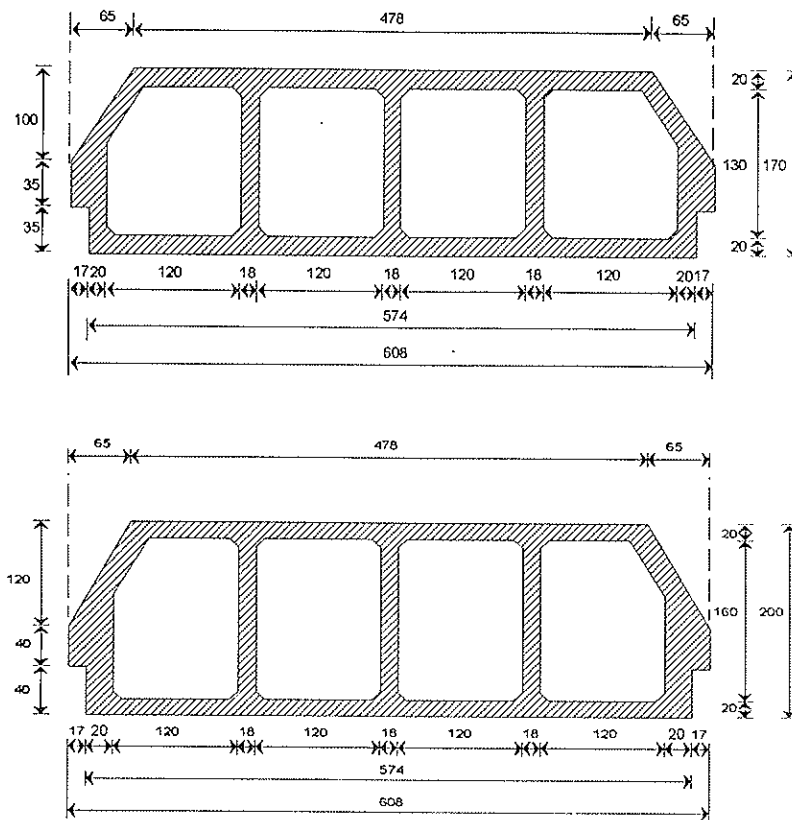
Detalle de bovedilla para forjado pretensado y armado. (Cotas en mm).
